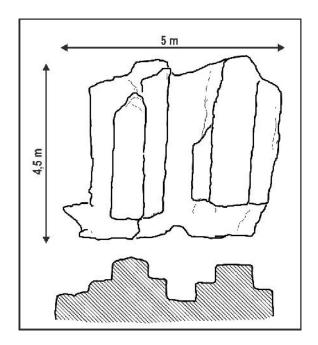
Croquis de planta y sección de las evidencias visibles del puente romano localizado en el municipio de Alpuente.
